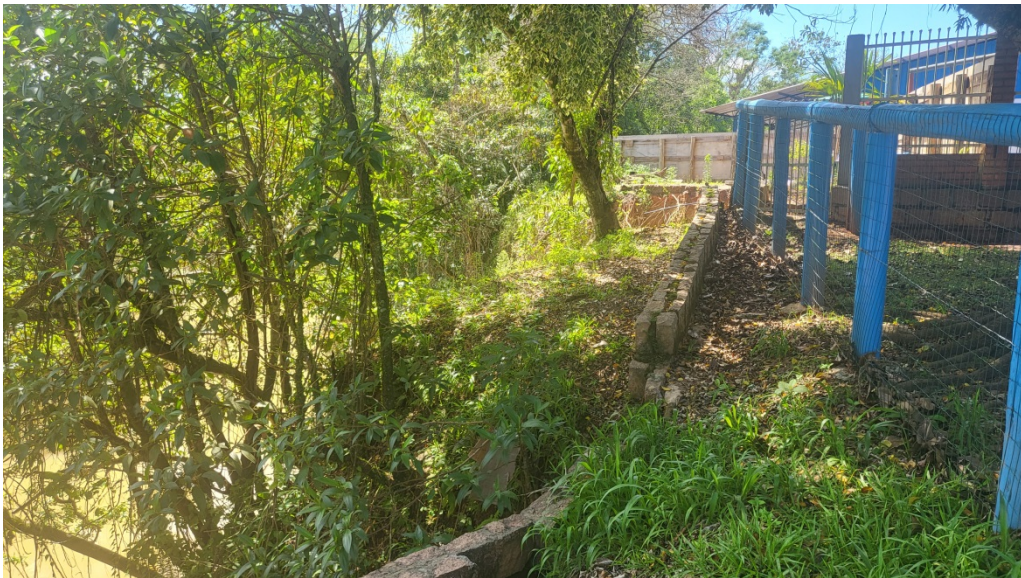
Talude de margem colapsado – Crista do talude, divisa com pátio da creche
